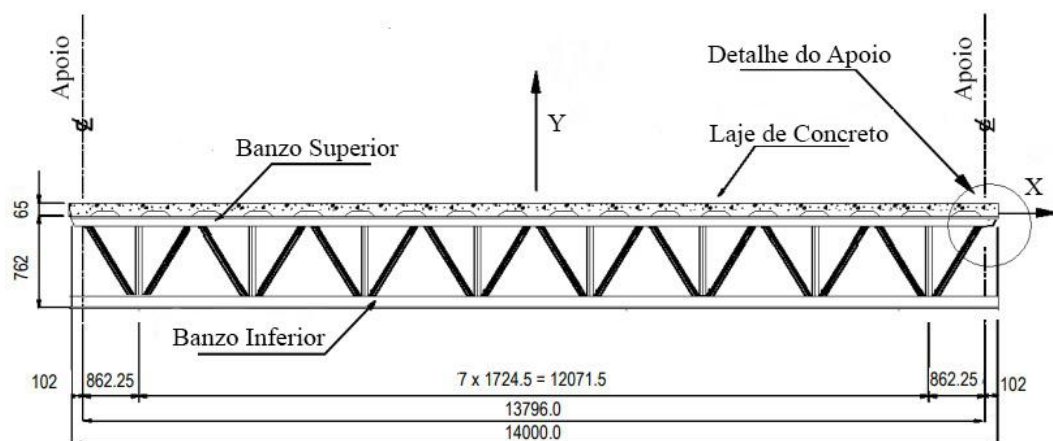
Corte A-A do piso misto (aço-concreto). Dimensões em mm.
